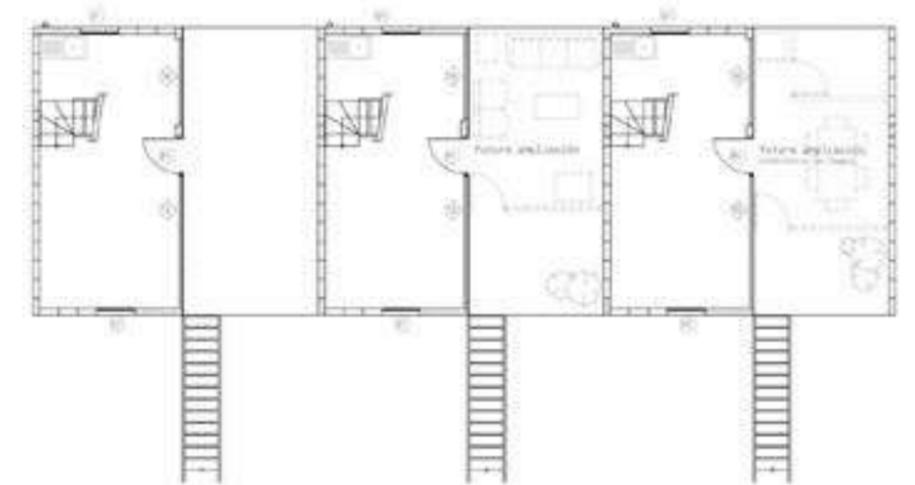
Quinta Monroy. Segundo Pavimento. Fonte. Archdaily/ELEMENTAL
